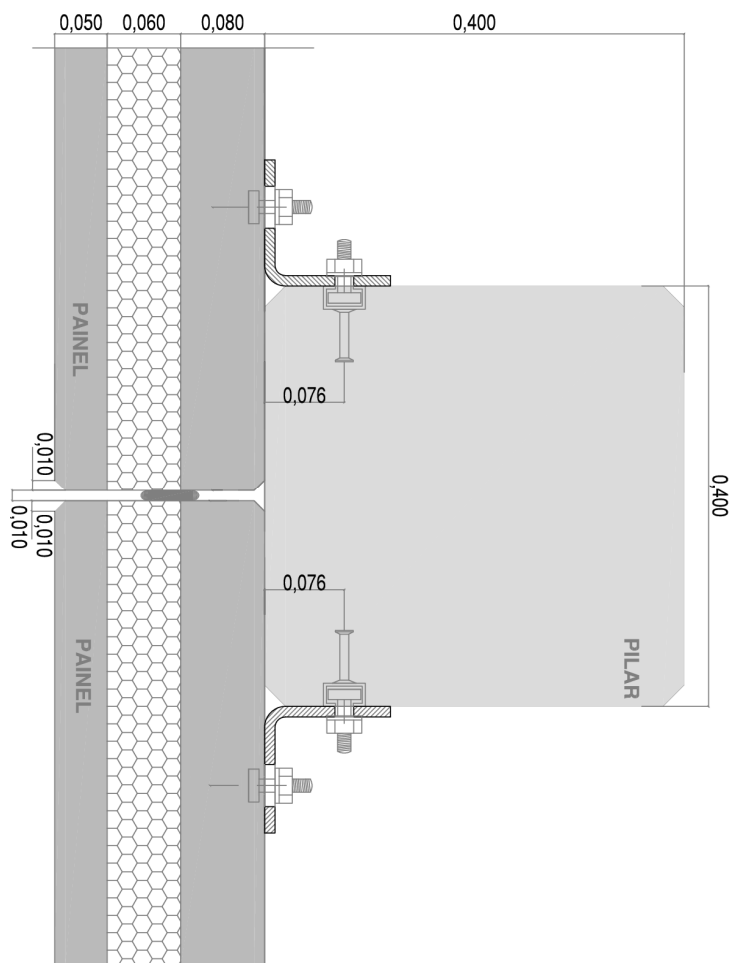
Dispositivo de Fixação – Jordahl k41/22 com 150 mm (sem escala) (Adaptada de Concremat, 2011)
